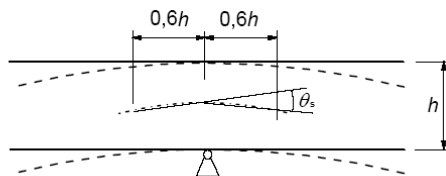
Plastische Rotation θ_s für Stahlbetonquerschnitte durchlaufender, stabförmiger Bauteile einschließlich durchlaufender einachsig gespannter Platten.
